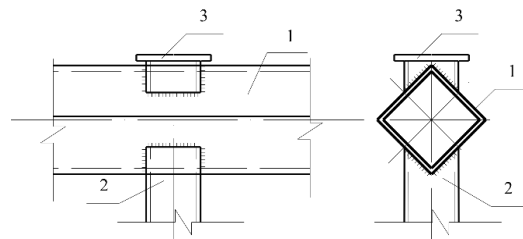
Узел фермы с поворотом поясов на 45° относительно собственной оси: 1 – верхний пояс, 2 – стойка, 3 – опора
